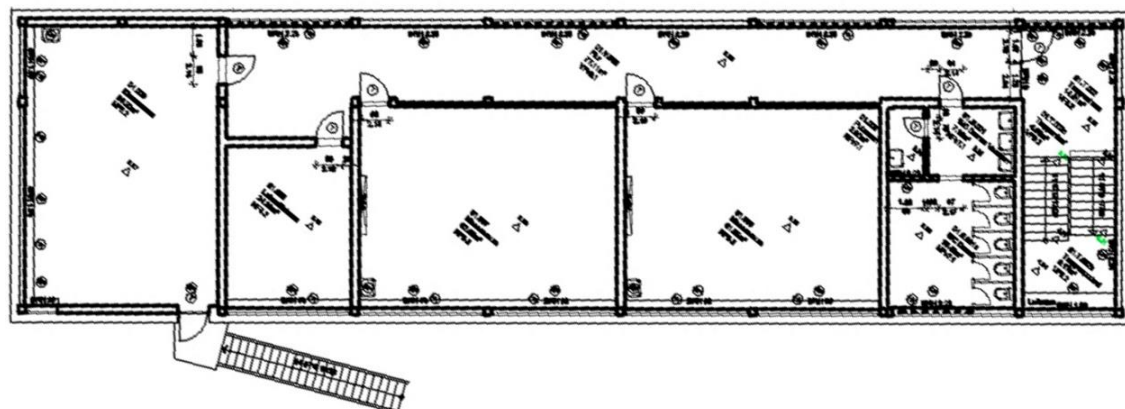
Ausschnitt 1. OG Grundriss Schulgebäude Trakt B
